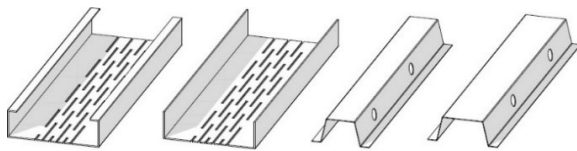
Стоечный, направляющий и шляпный оцинкованные профили ЛСТК
